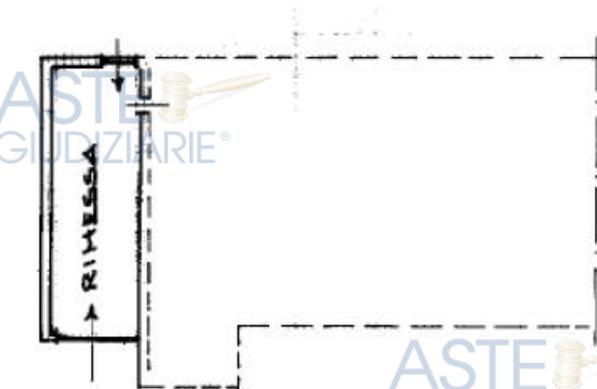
Estratto di planimetria catastale del 07.12.1993 n. T50520
